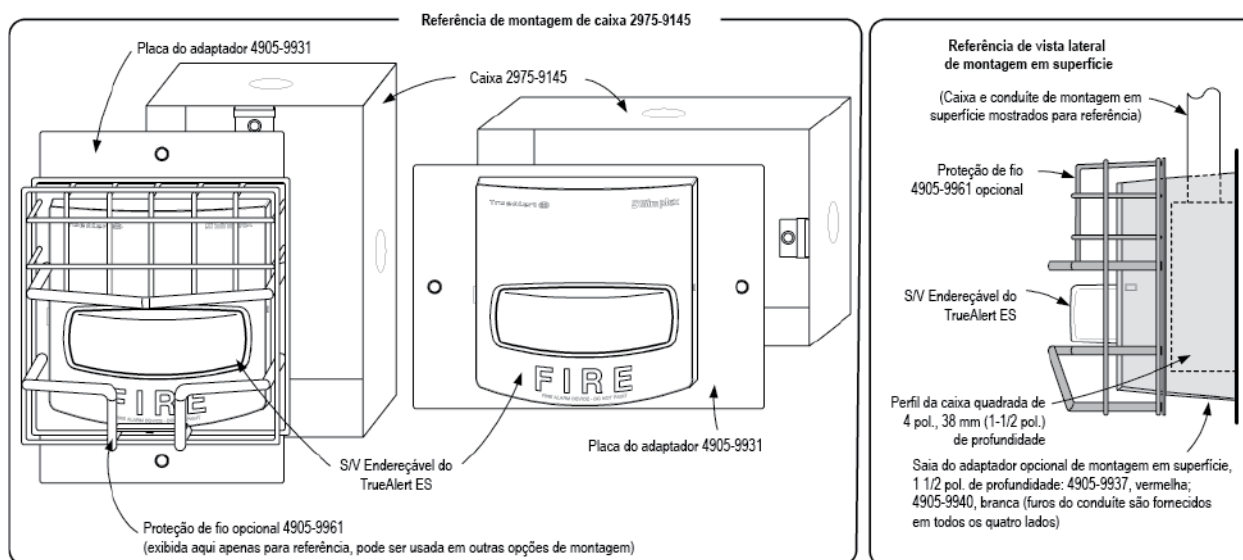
Referência de Instalação da Placa do Adaptador e Montagem de Superfície
